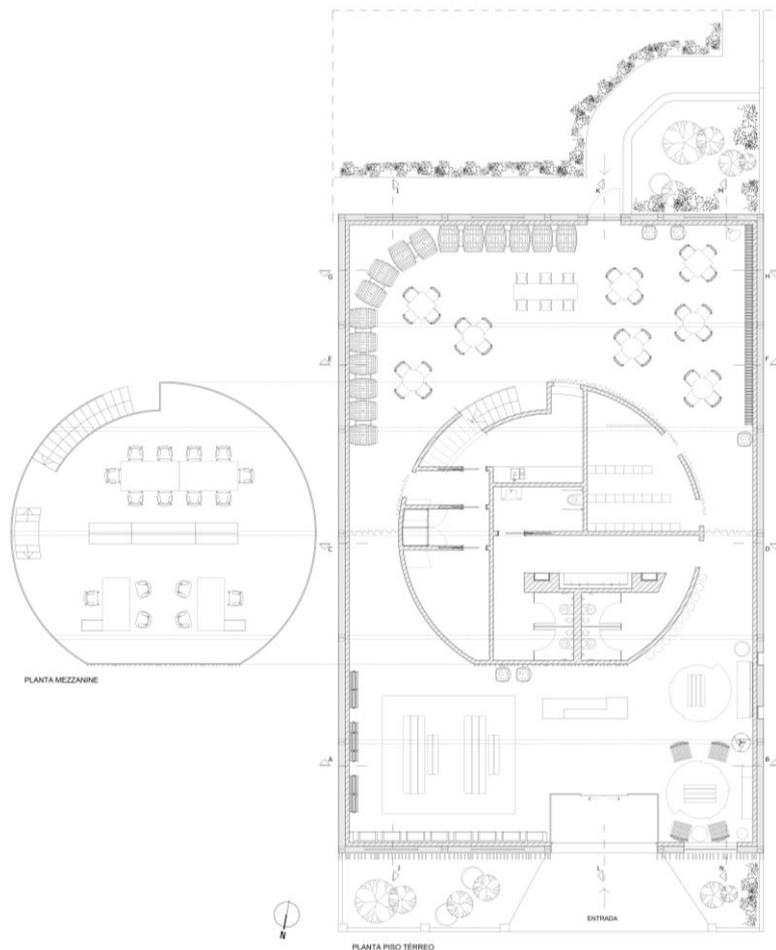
Desenho Técnico - Planta de Apresentação. Fonte: (Autor)
